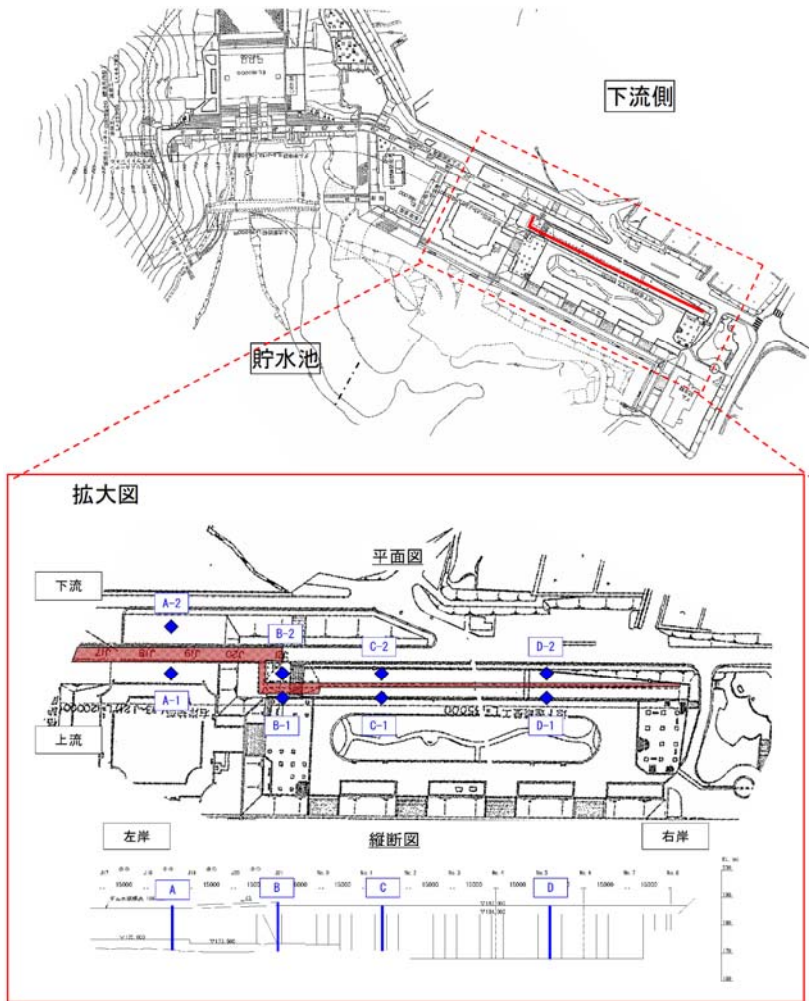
ダム右岸袖部・地下連続壁の平面図・縦断面図
